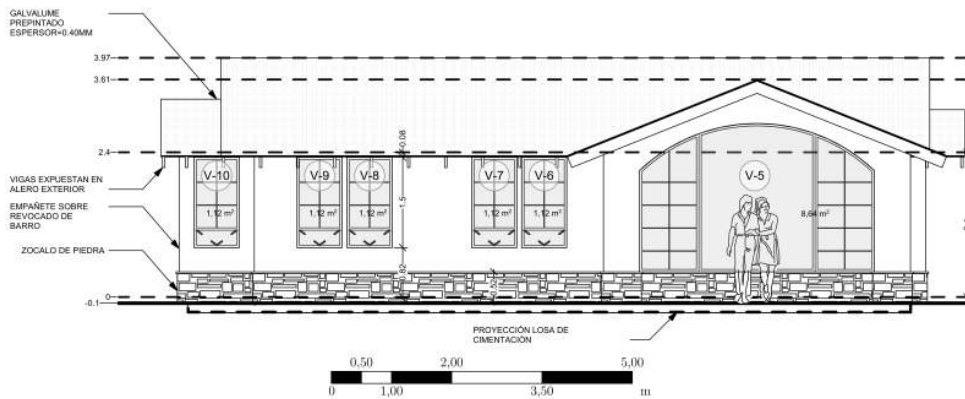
Elevación lateral izquierda (Este) del proyecto para Sr. Gerardo Campoverde.
